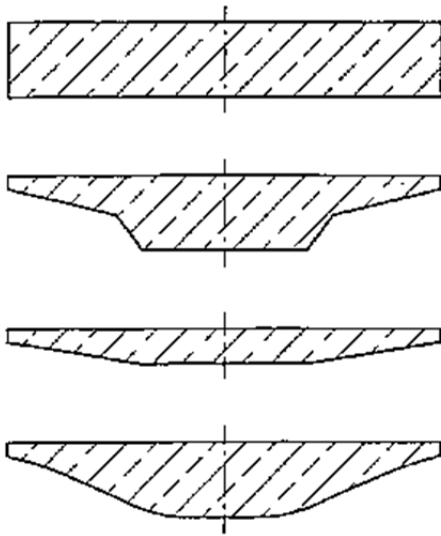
Vollplatte – Ortbetonkonstruktionen<sup>6</sup>
